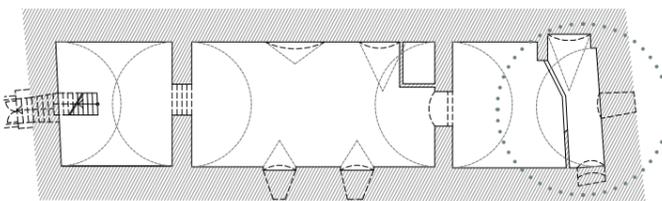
Lage ehemalige Kellertreppe, Grundriss Kellergeschoß
